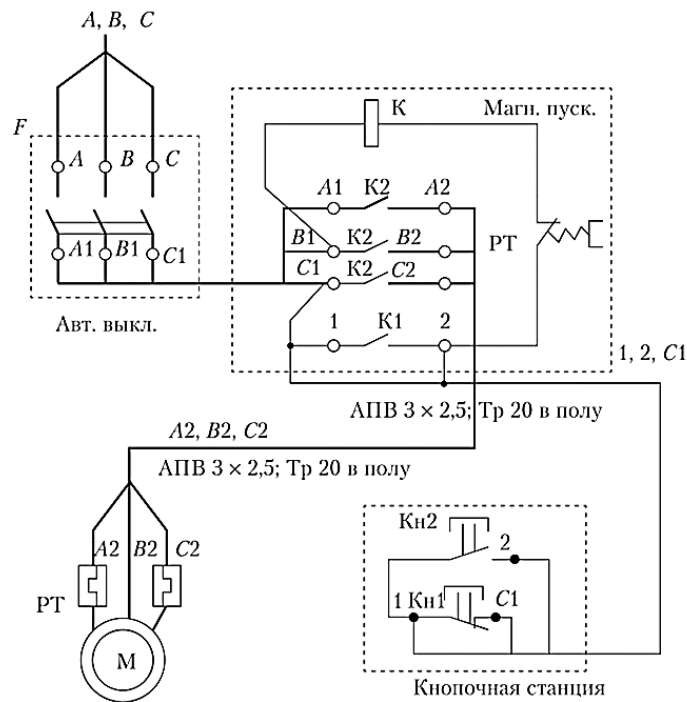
Схема соединений подключения двигателя через магнитный пускатель и кнопочную станцию
